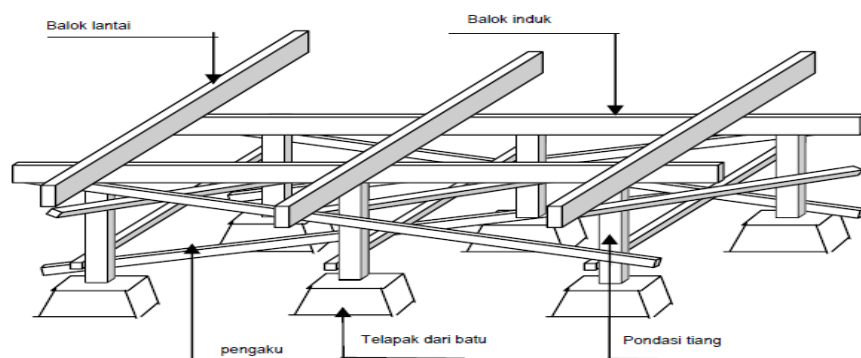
Detail balok pengikat untuk pondasi umpak/setempat
